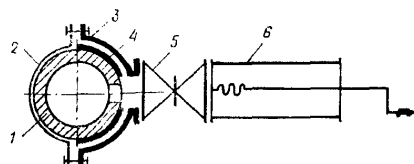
Схема устройства для присоединения ввода: 1 – труба наружного водопровода; 2 – хомут; 3 – седелка; 4 – прокладка уплотнительная; 5 – проходная задвижка; 6 – сверильное приспособление
